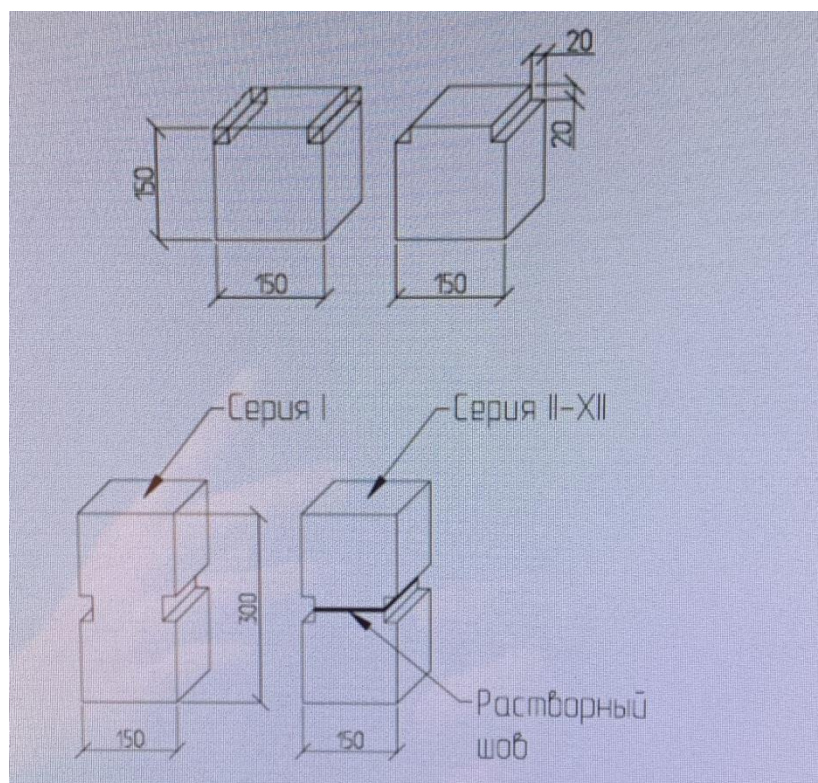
Общий вид образцов для испытаний на нормальное сцепление
